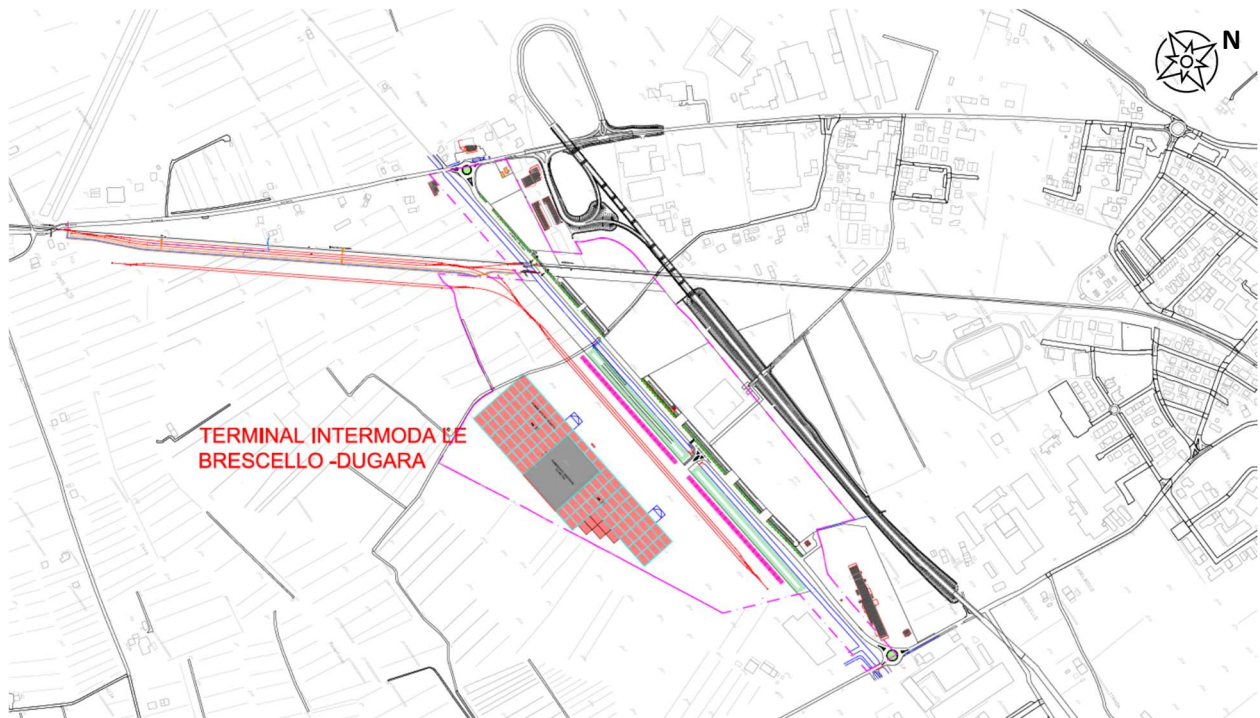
Layout di progetto della nuova logistica e completamento ferrovia e scalo ferroviario
